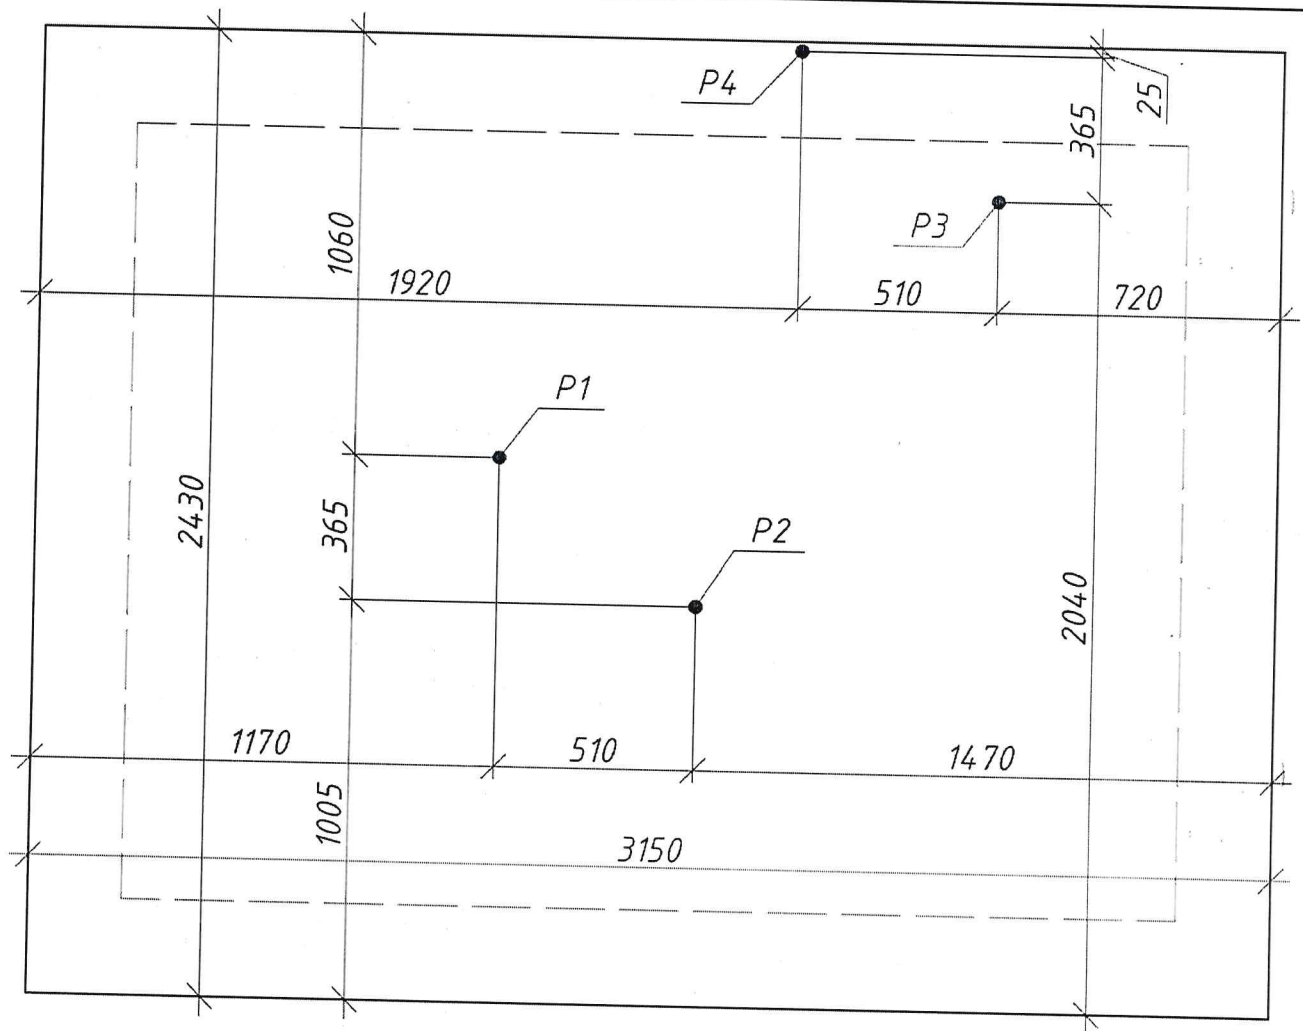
Нагрузки на плиту перекрытия шахты от лифтового оборудования
